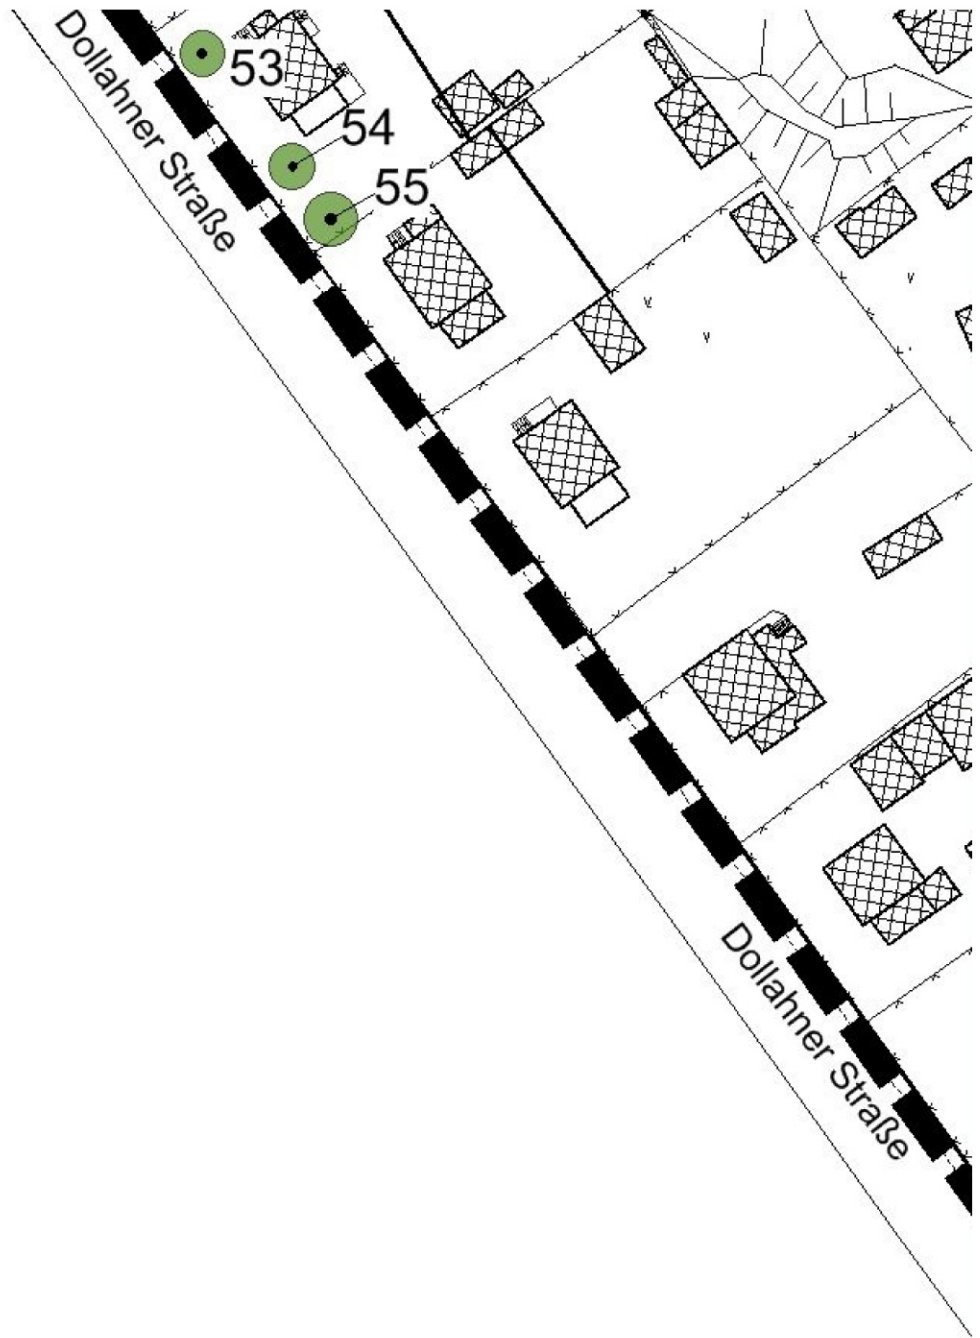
Bestand Bäume, Detailplan C, unmaßstäblich
